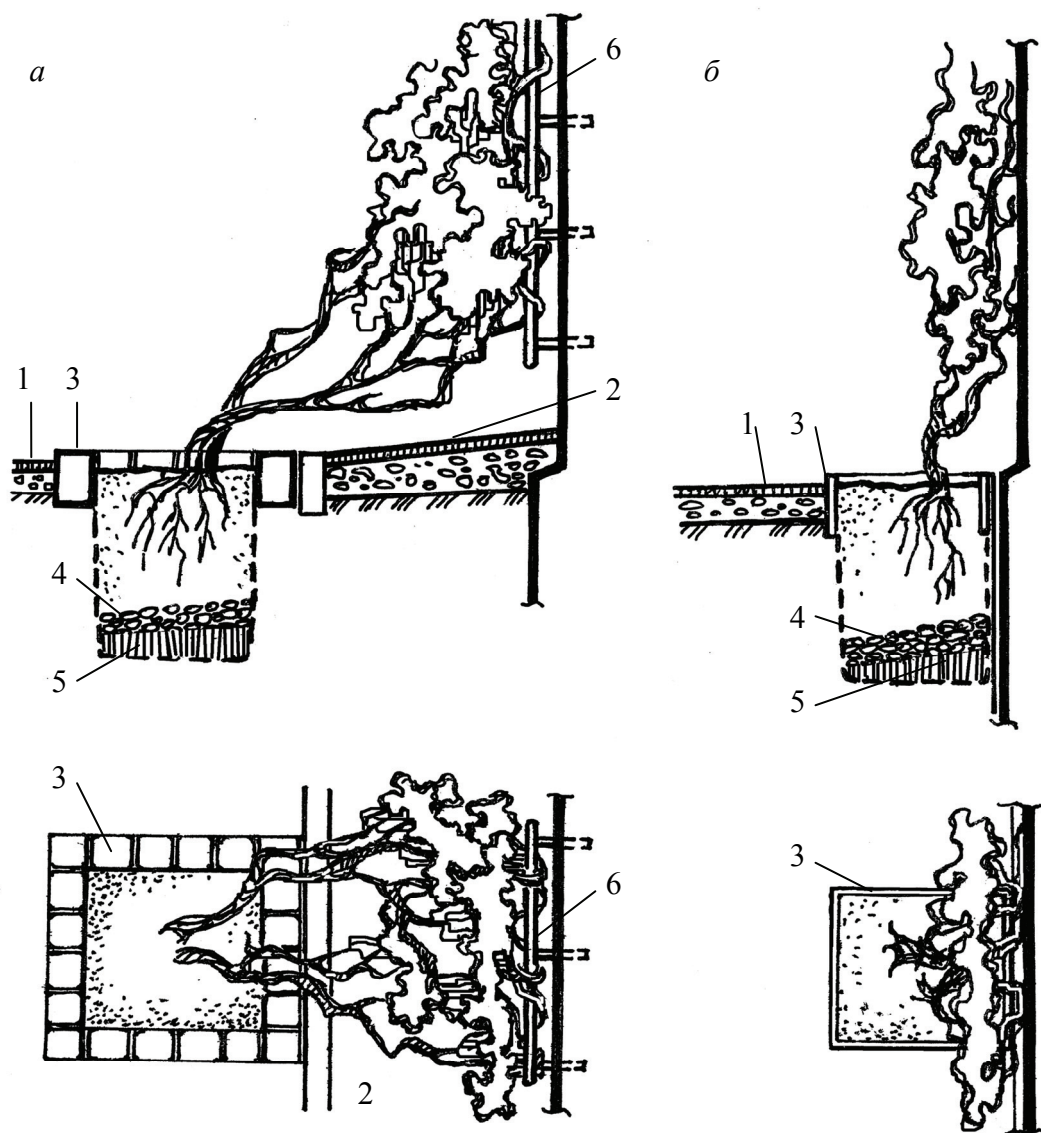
Схемы посадки лиан для вертикального озеленения фасадов:
